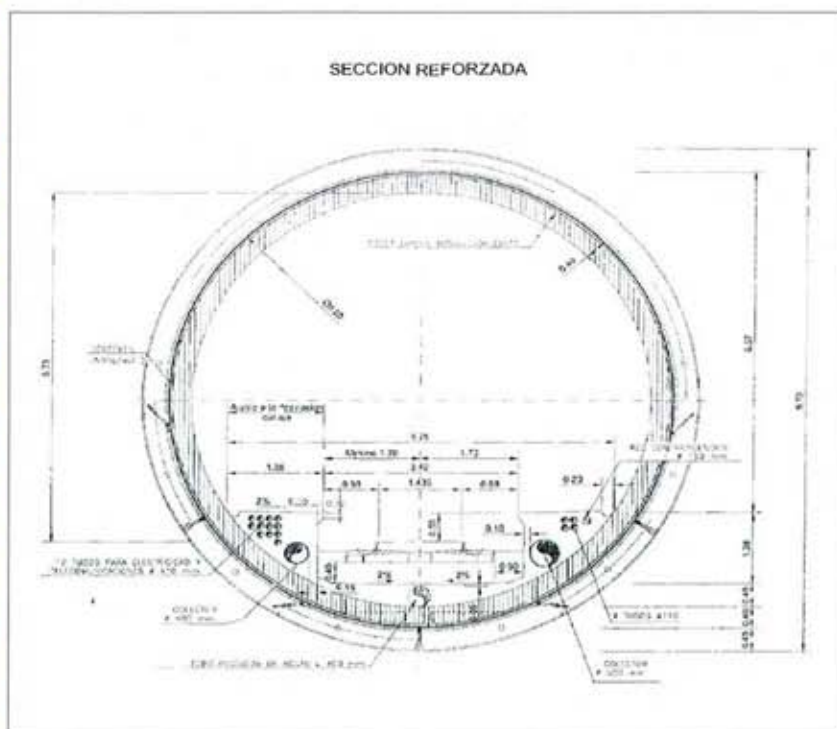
Sección del túnel reforzada con hormigón autocompactante.
